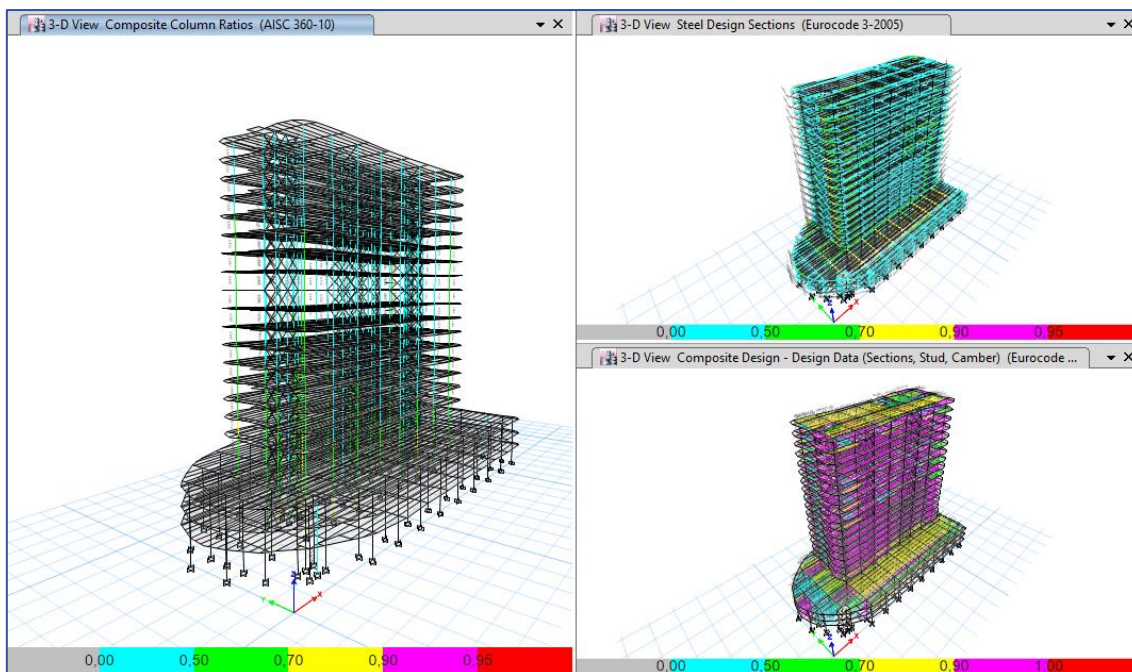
Comprobación demanda/capacidad vigas, vigas compuestas, columnas y columnas compuestas.
